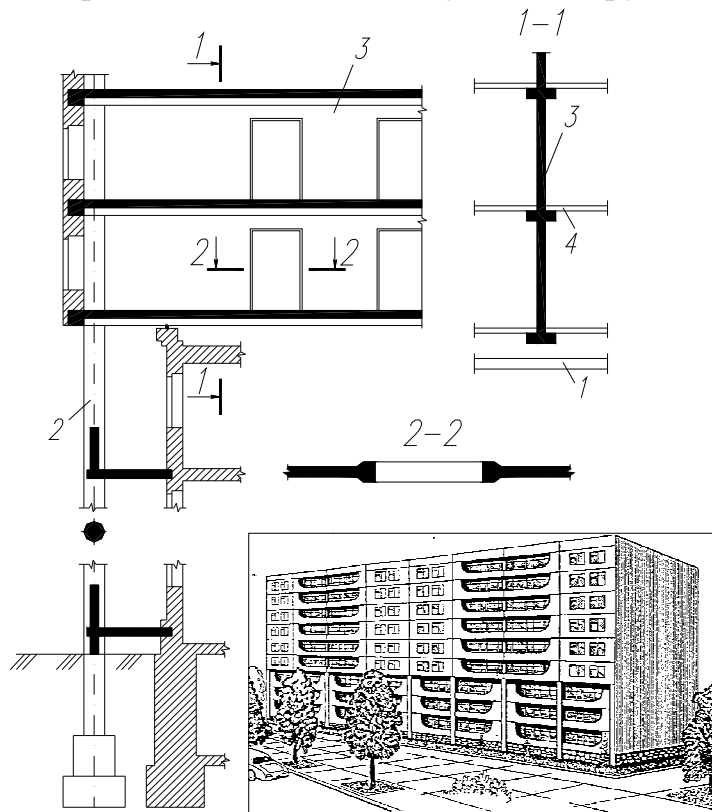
Ненагружающая шестиэтажная надстройка с балками-стенками 1 – старое здание; 2 – колонны, несущие надстройку; 3 – балка-стенка; 4 – перекрытия надстройки
